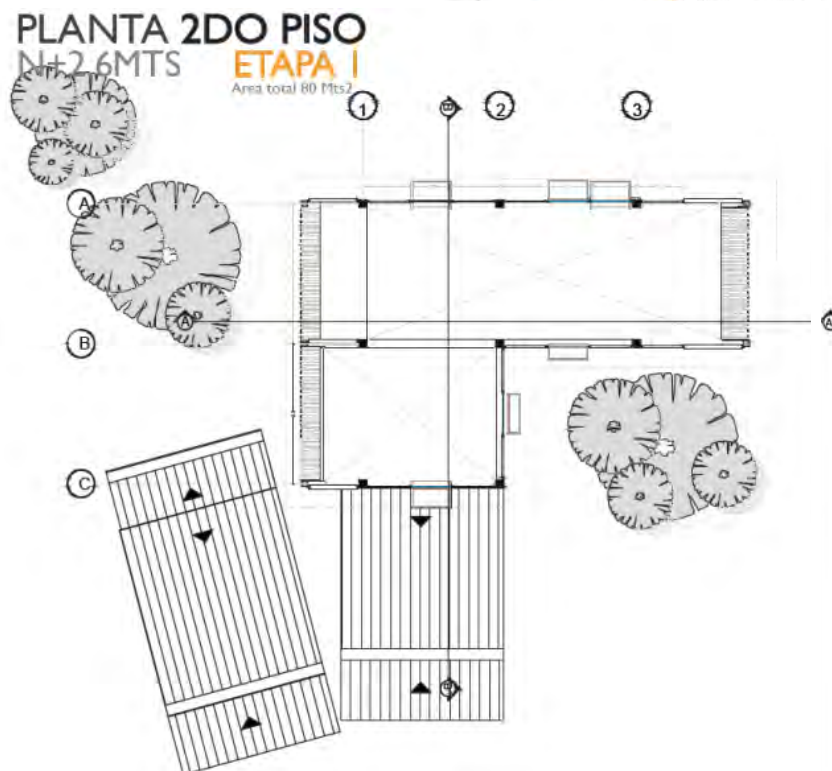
Planta 2 piso, primera etapa vivienda A2 Fuente: propia
